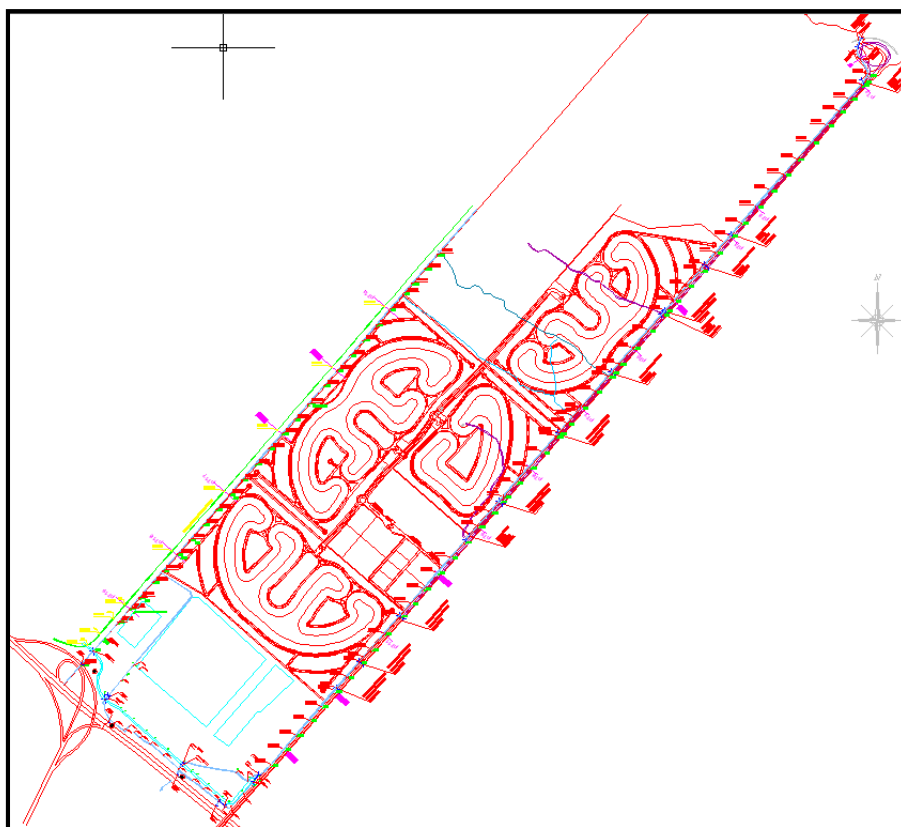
Planimetría de Relevamientos Topográficos Recopilados.
